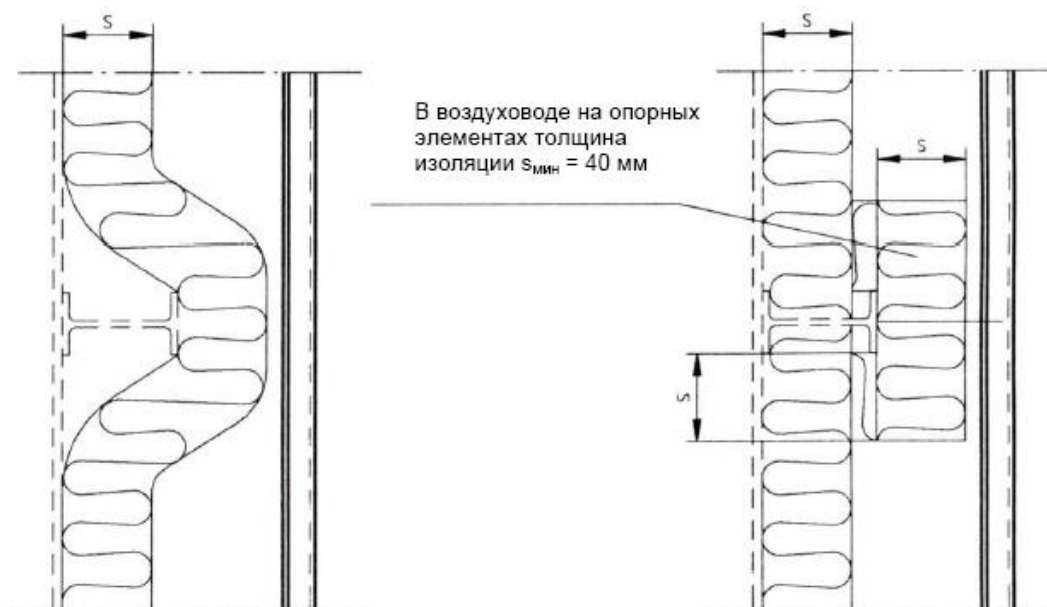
Теплоизоляция опорных элементов для электрофильтров, воздухопроводов и газоходов
